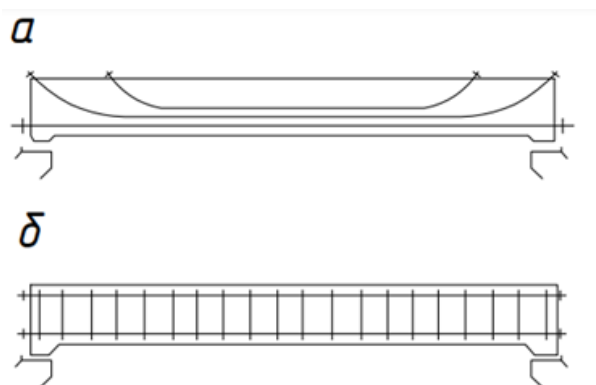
Схема армирования предварительно напряженных балок: а) криволинейная напрягаемая арматура, б) прямолинейная арматура
